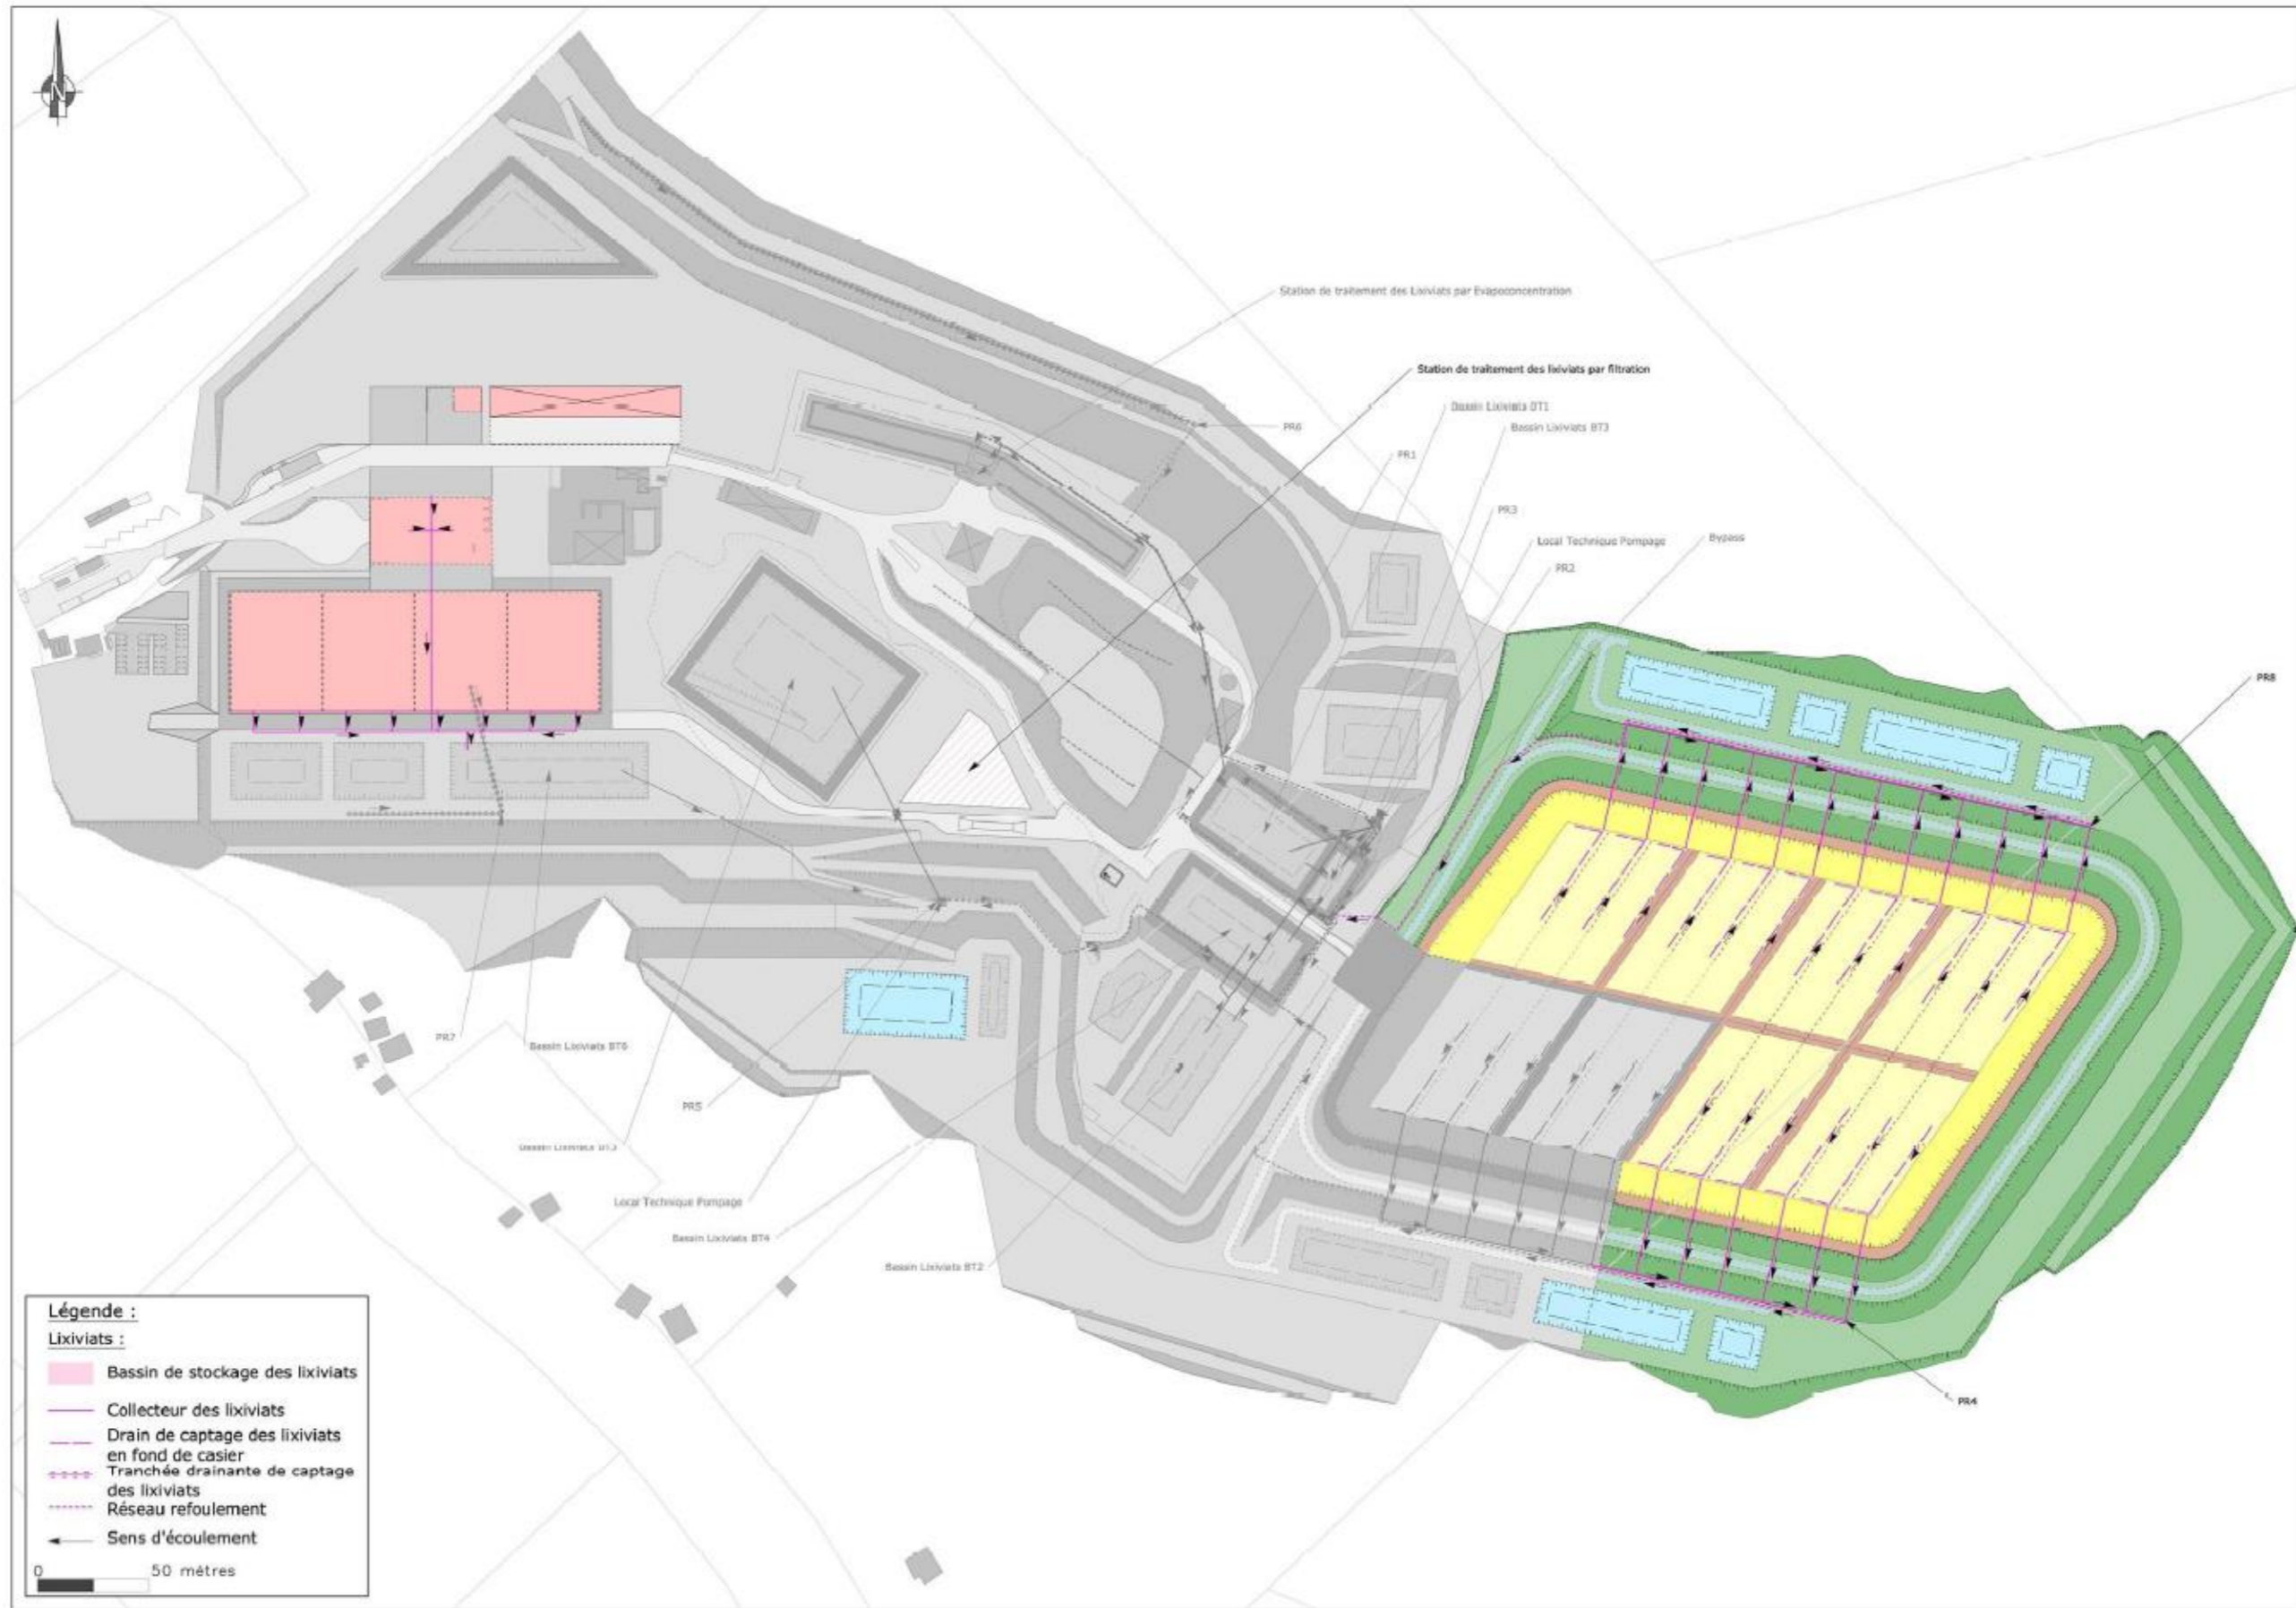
Plan du réseau de collecte des lixiviats niveau 1 (Source : BETA Environnement)
